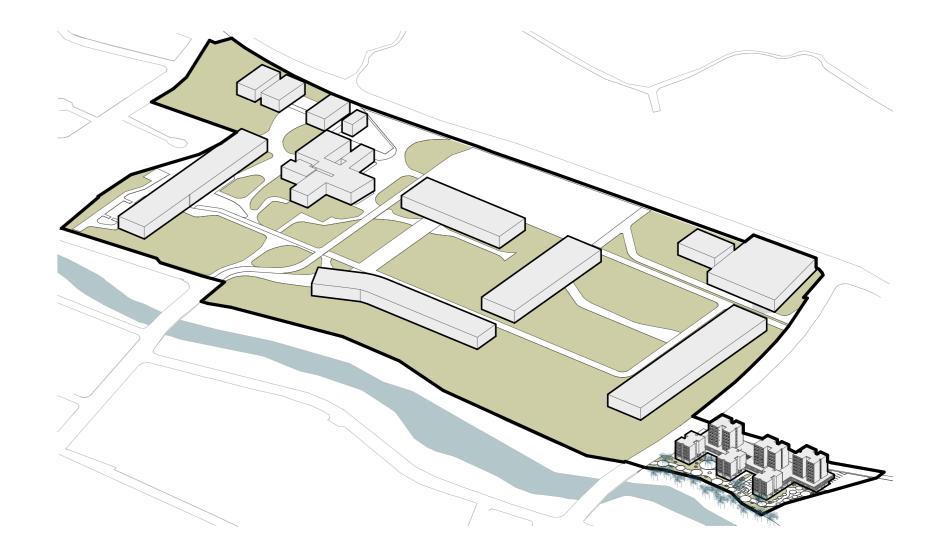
Anteproyecto Arquitectónico Fuente Autoría Propia
